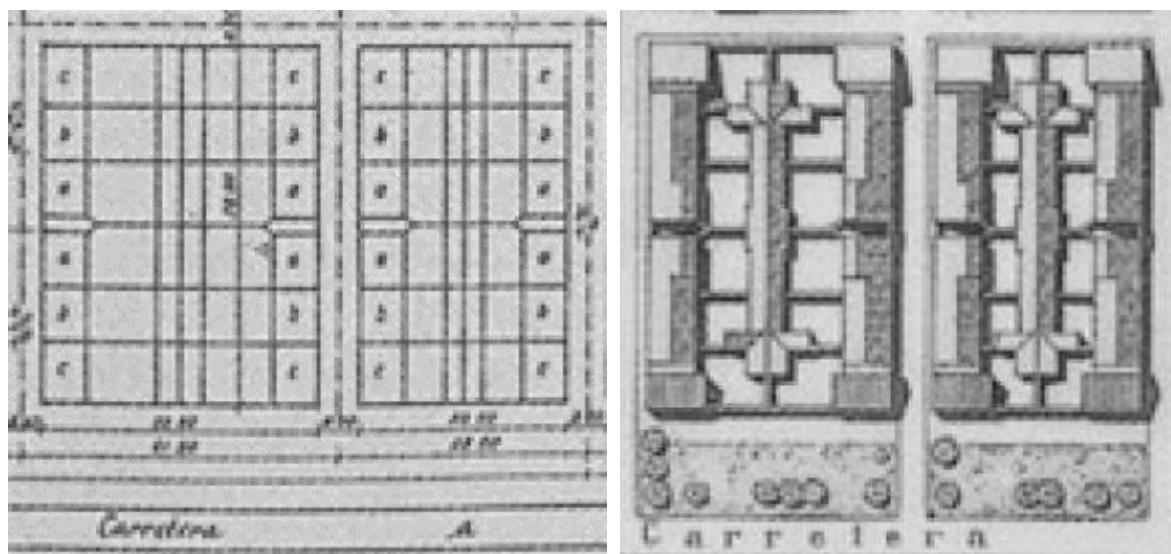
Imágenes de las dos primeras manzanas en el Proyecto de ordenación del nuevo pueblo de Villanueva de la Cañada. 1942
